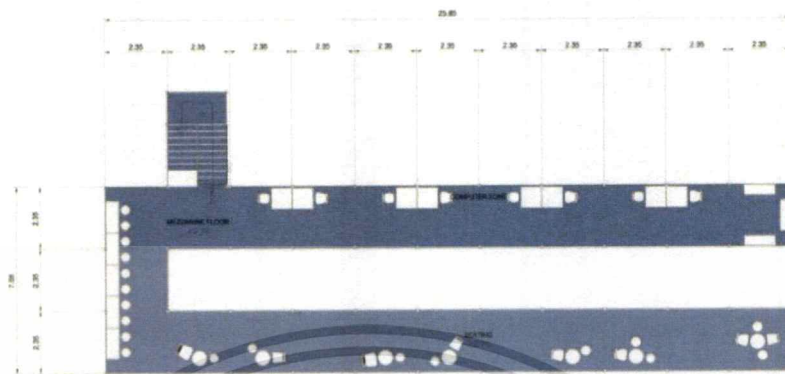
แสดงผังบริเวณภายในชั้นลอยอาคารพักอาศัย (LIVING BUILDING MEZZANINE FLOOR PLAN)
